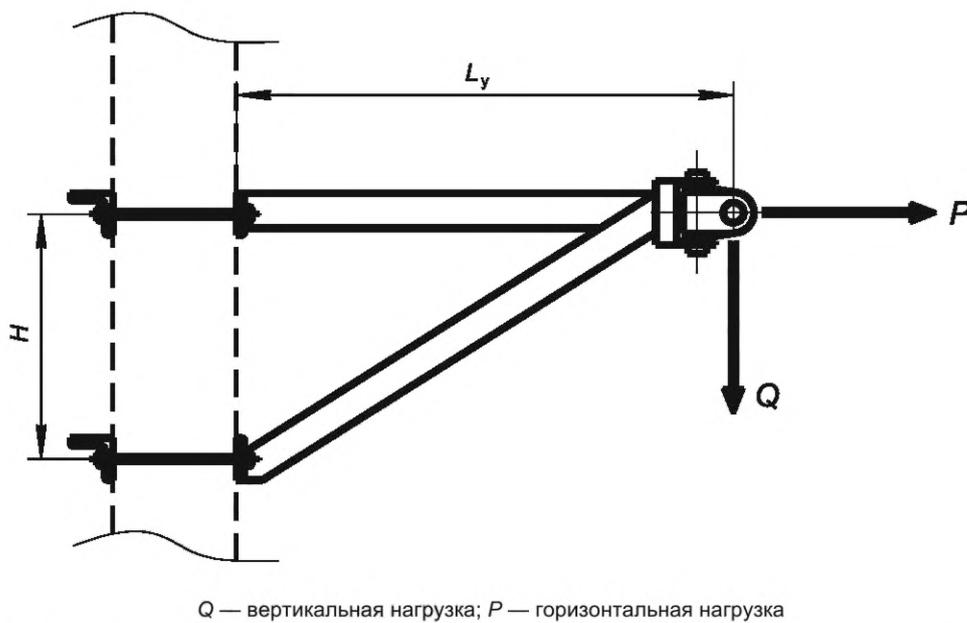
Основные размеры узлов крепления тяги и пяты консоли с удлинителем и схемы приложения нагрузок
